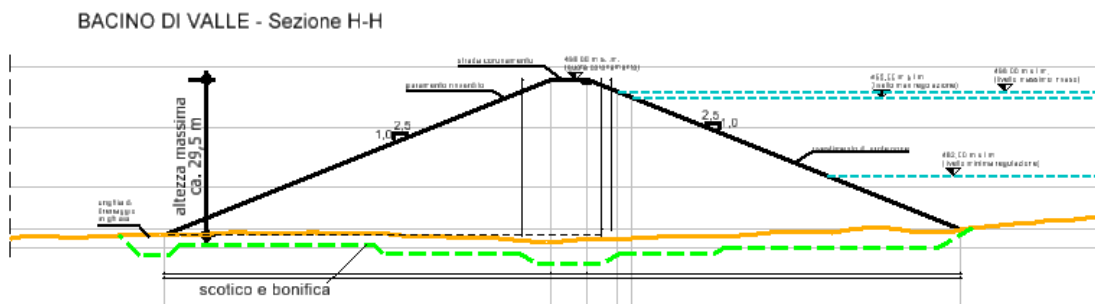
Sezione oggetto di verifica (Sezione H-H).
